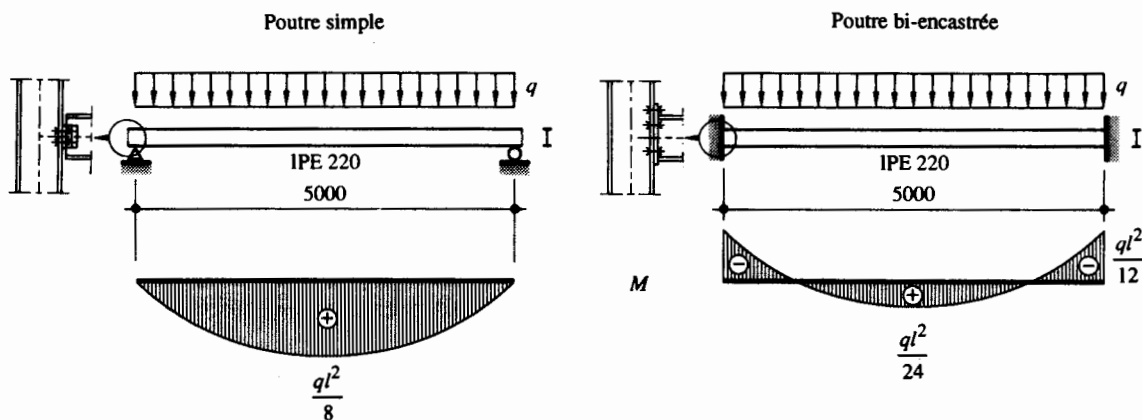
Systèmes statiques et conditions de chargement des poutres.
